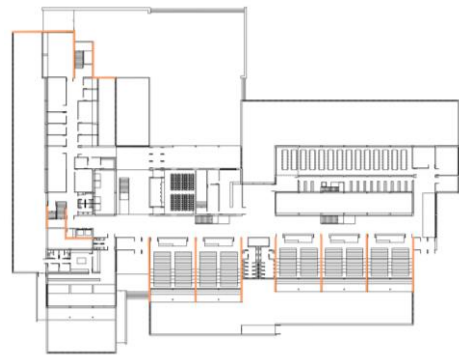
Esquema ubicación fachada G.R.C sobre pantalla de hormigón. Fuente: Elaboración propia
